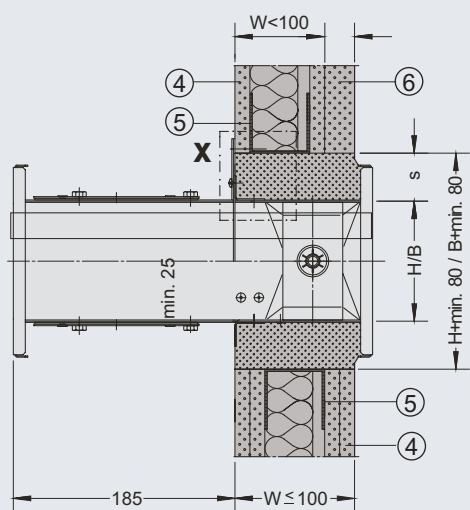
Montagem "molhada" - espessura da parede W de acordo com a indicação do fabricante
